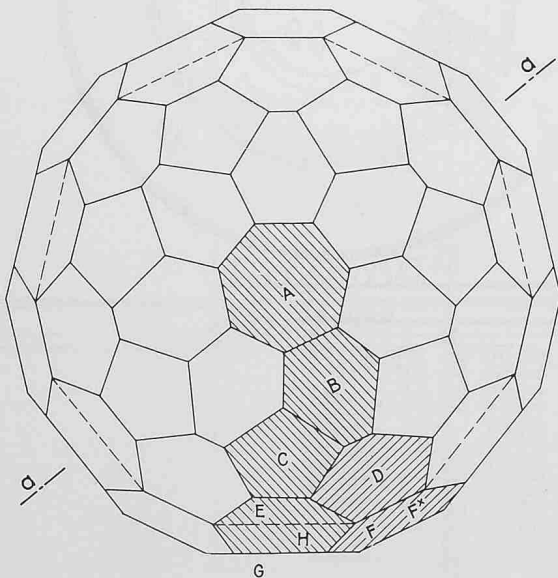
Projektionskuppel, Grundriss 1:250 des Stahlskeletts
